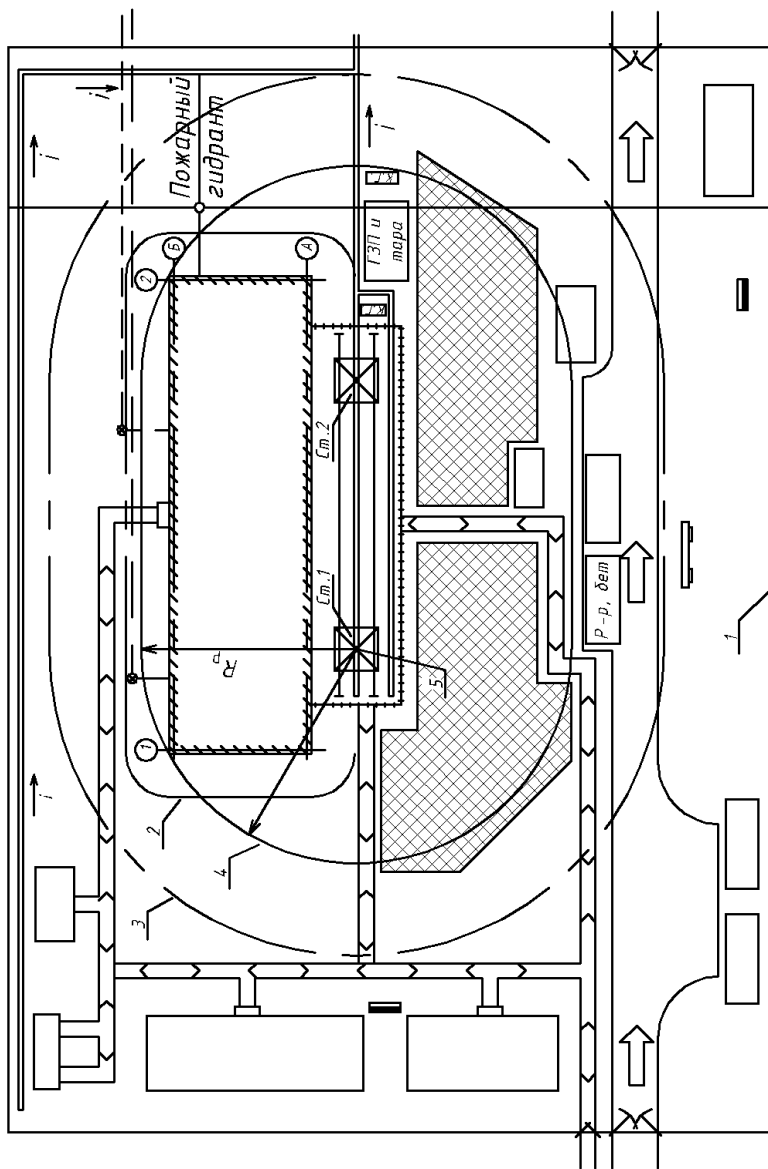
Определение границ зон при работе башенных кранов:
